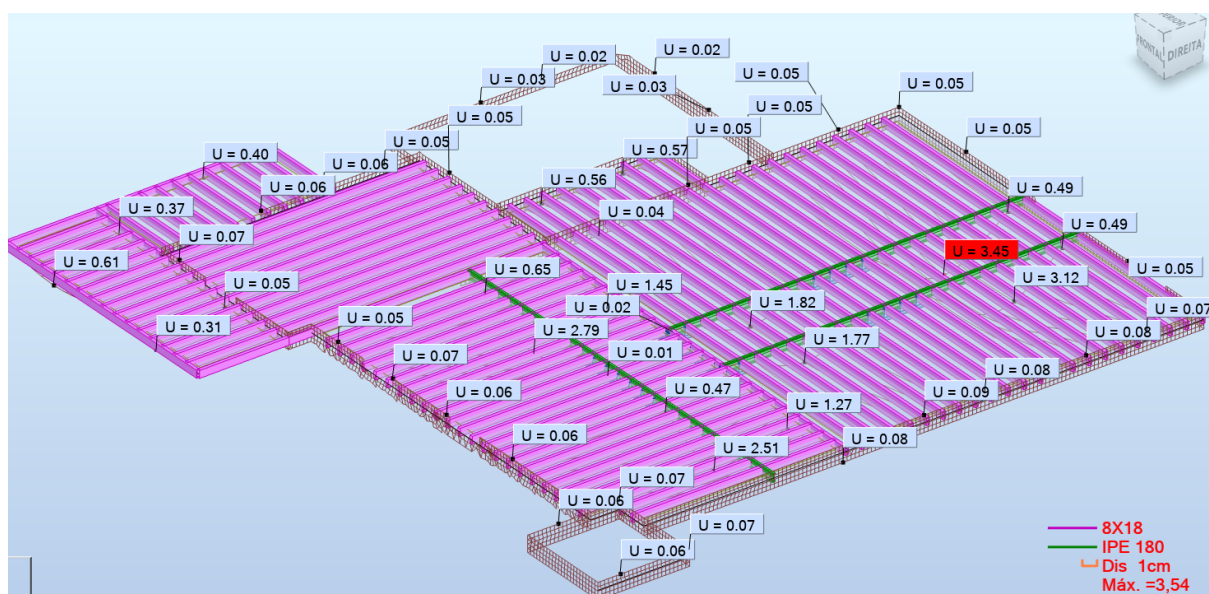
Deformação do pavimento (Piso 1) nas condições atuais
